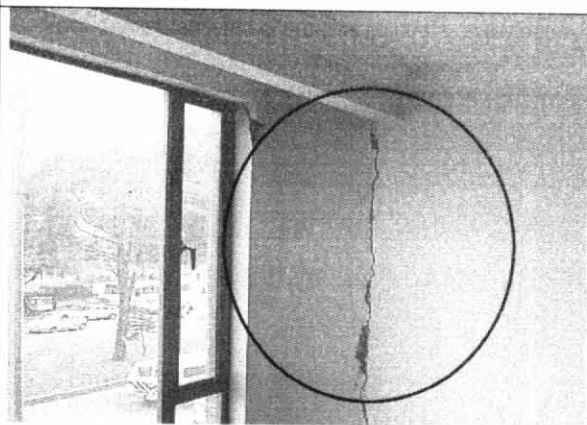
Agrietamiento de muro no estructural al interior del inmueble sobre la fachada del piso tres (3).
